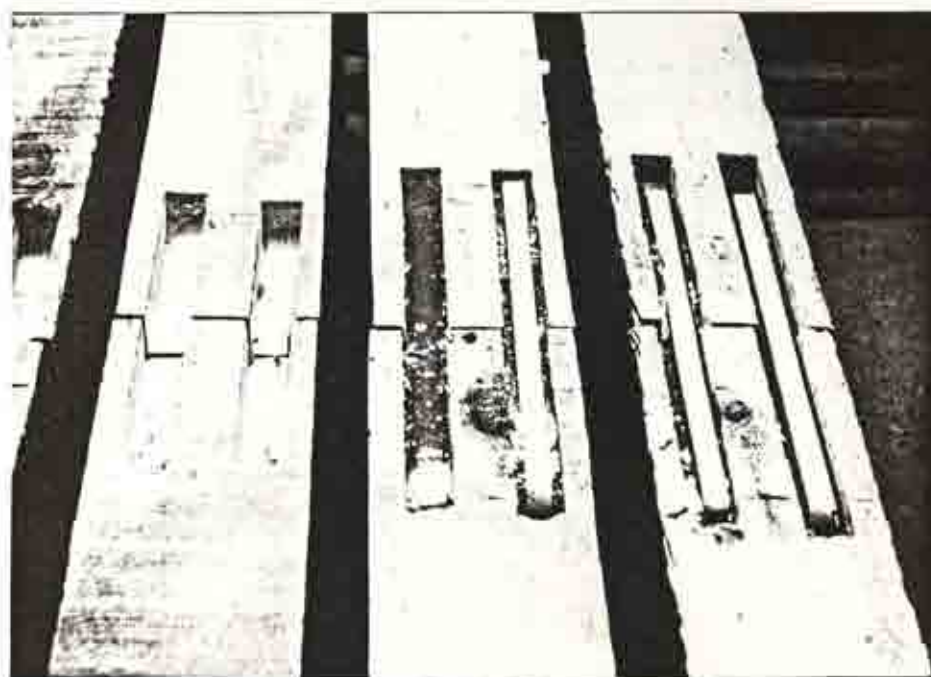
Instalación de los perfiles de sección rectangular en los ranurados. Vertido de la formulación S.42. En vigas unidas en el centro de la luz.
